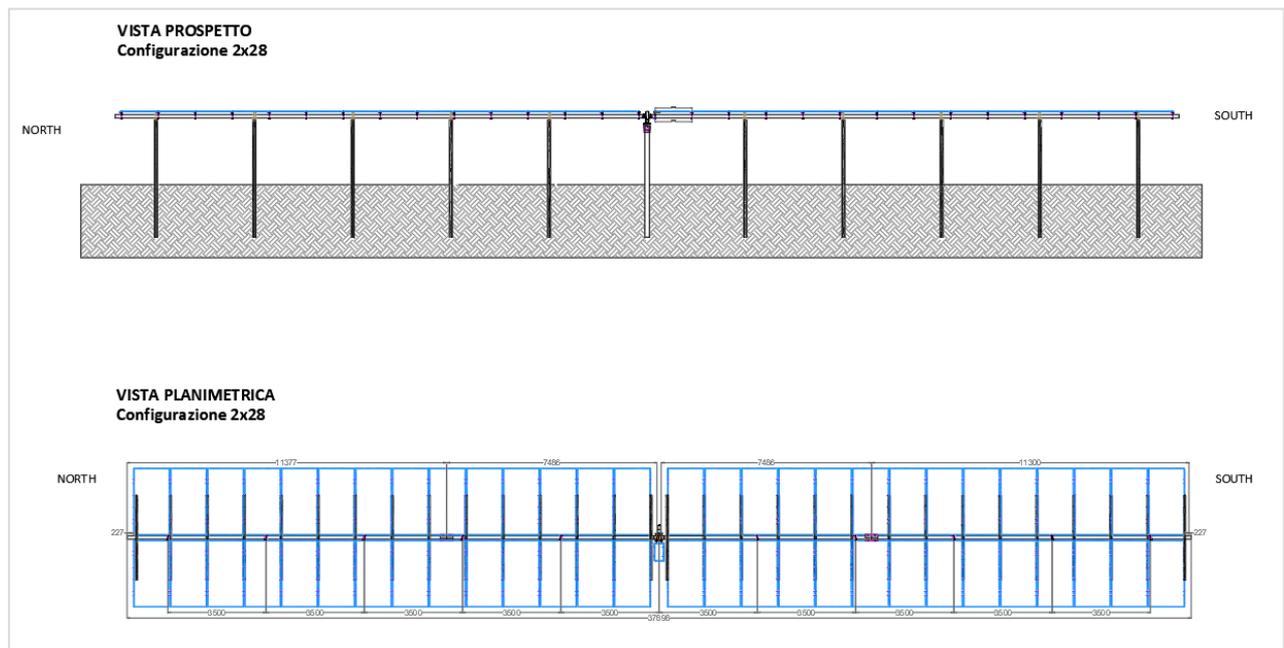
Vista del prospetto e planimetrica delle strutture porta-moduli tracker 2x28
